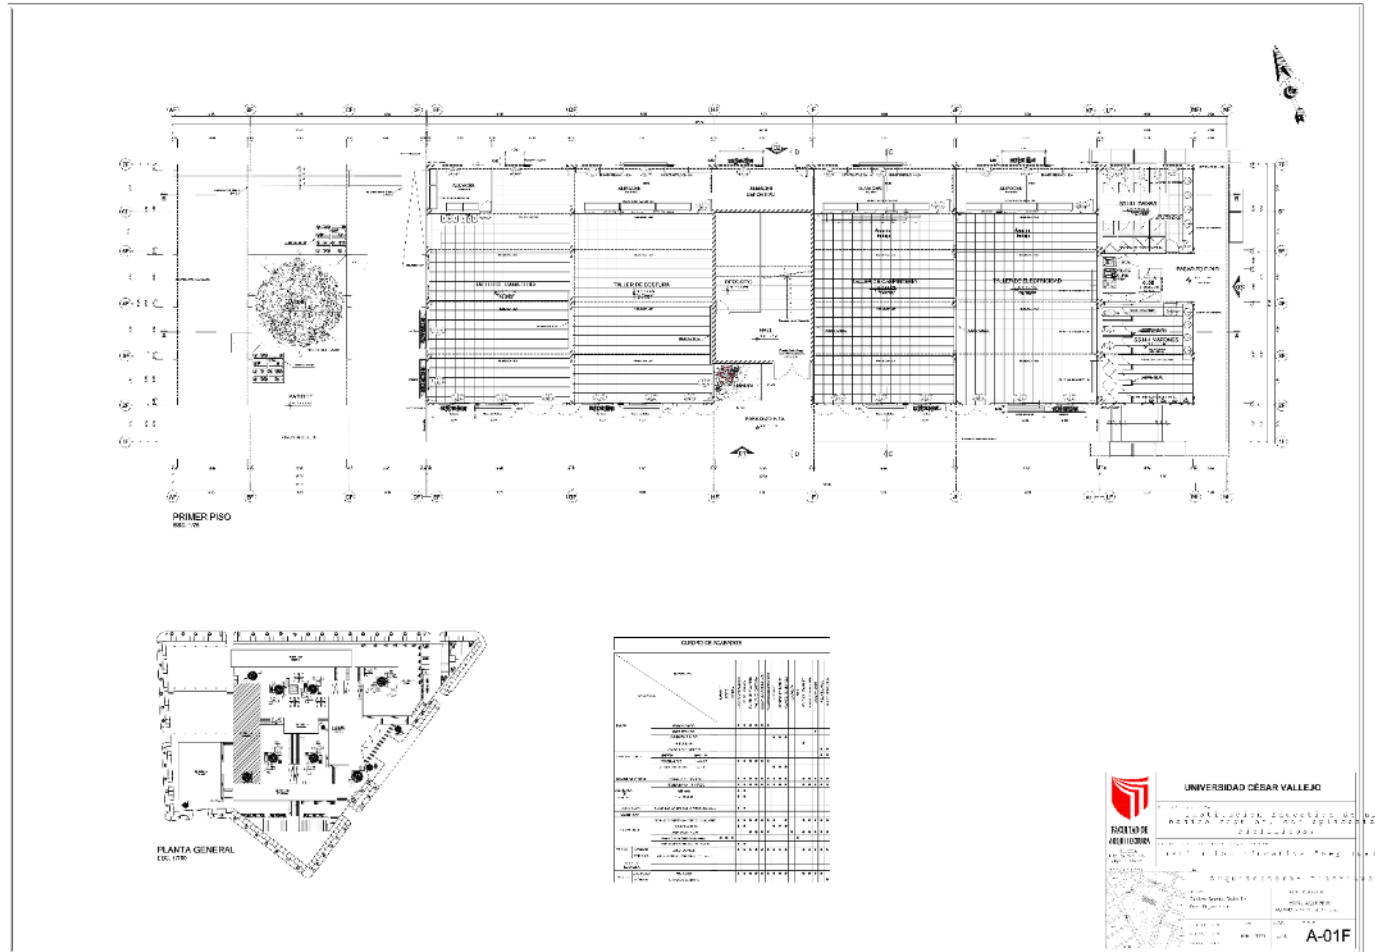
Plano primera planta bloque "F", Fuente: elaboración propia
